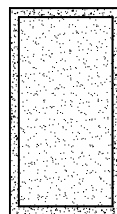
Rompeolas a escala natural de concreto reforzado.
